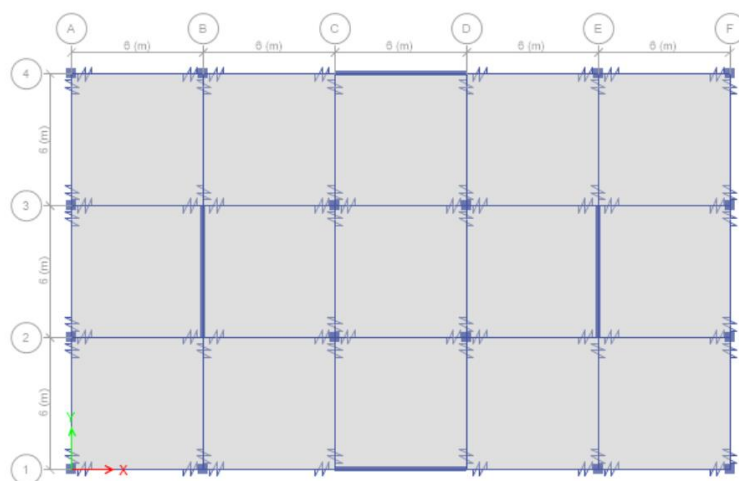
Distribución de rótulas perfectas en planta estructura auxiliar Edificio Tipo 3
